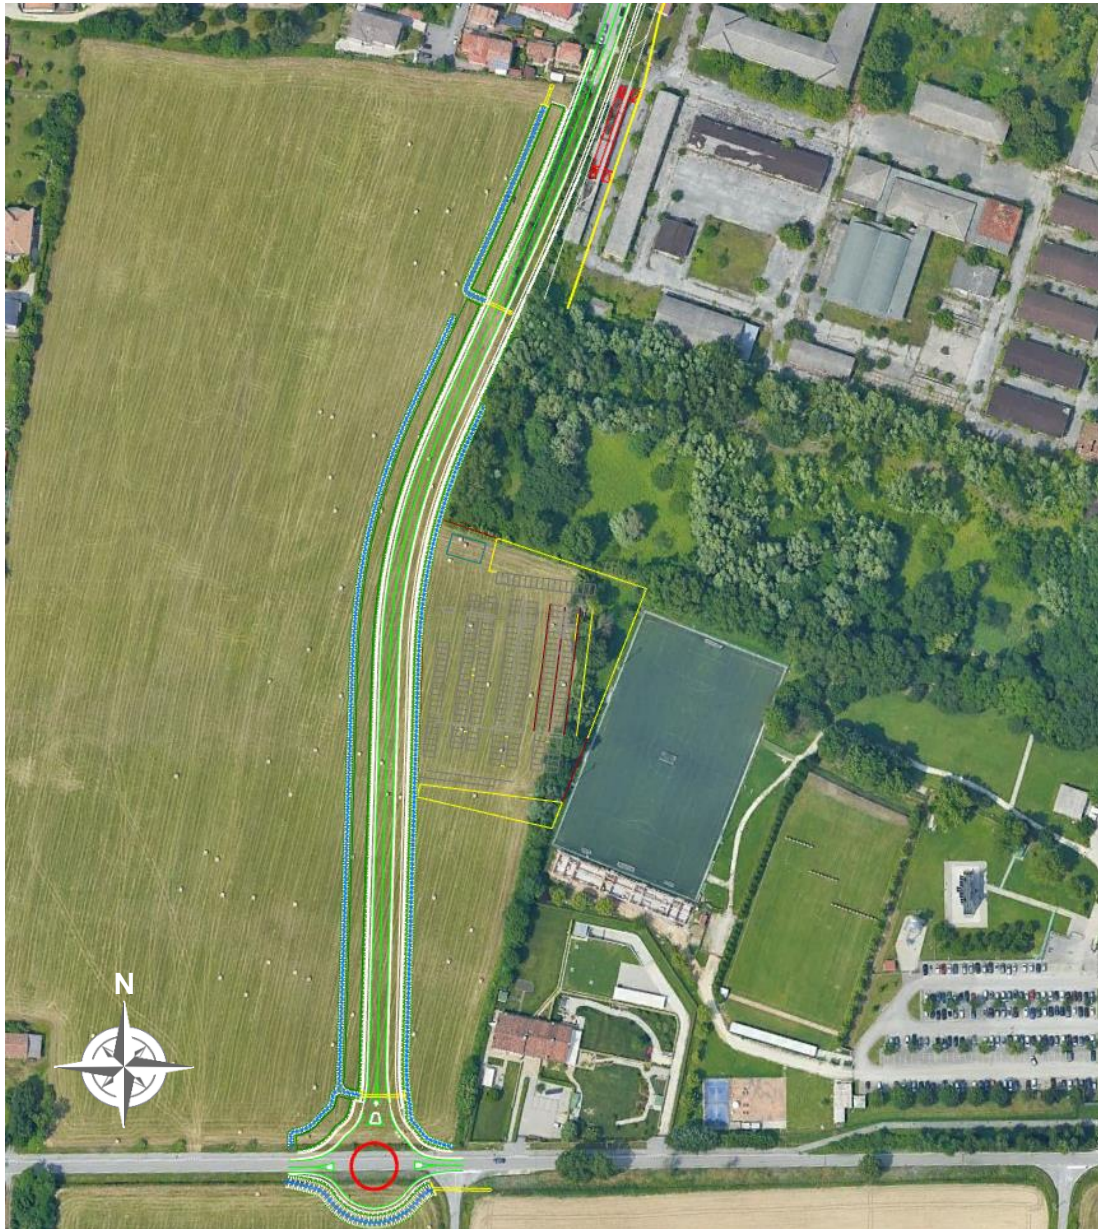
Vista aerea dell'area 2 di intervento con sovrapposizione dell'intervento di progetto (fonte Google Earth).
